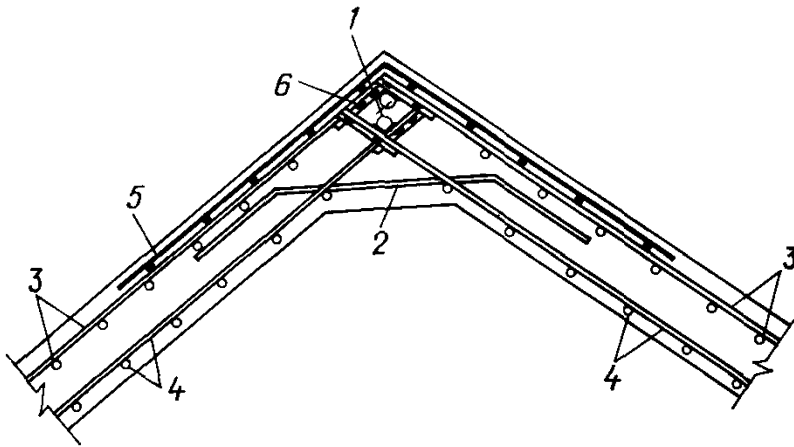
Анкеровка наружных сеток в углу воронки с помощью дополнительной сетки
